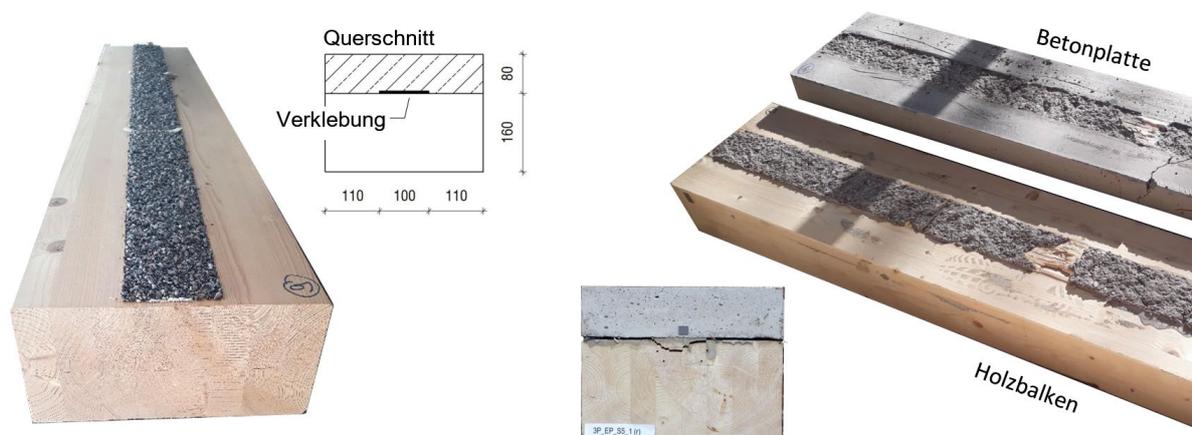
Kurze Biegeschubträger mit schmaler Fuge: Links: Vor dem Betonieren. Rechts: Nach den Versuchen mit Beton- und Holzversagen. Das Bild zeigt vorwiegend Betonversagen
